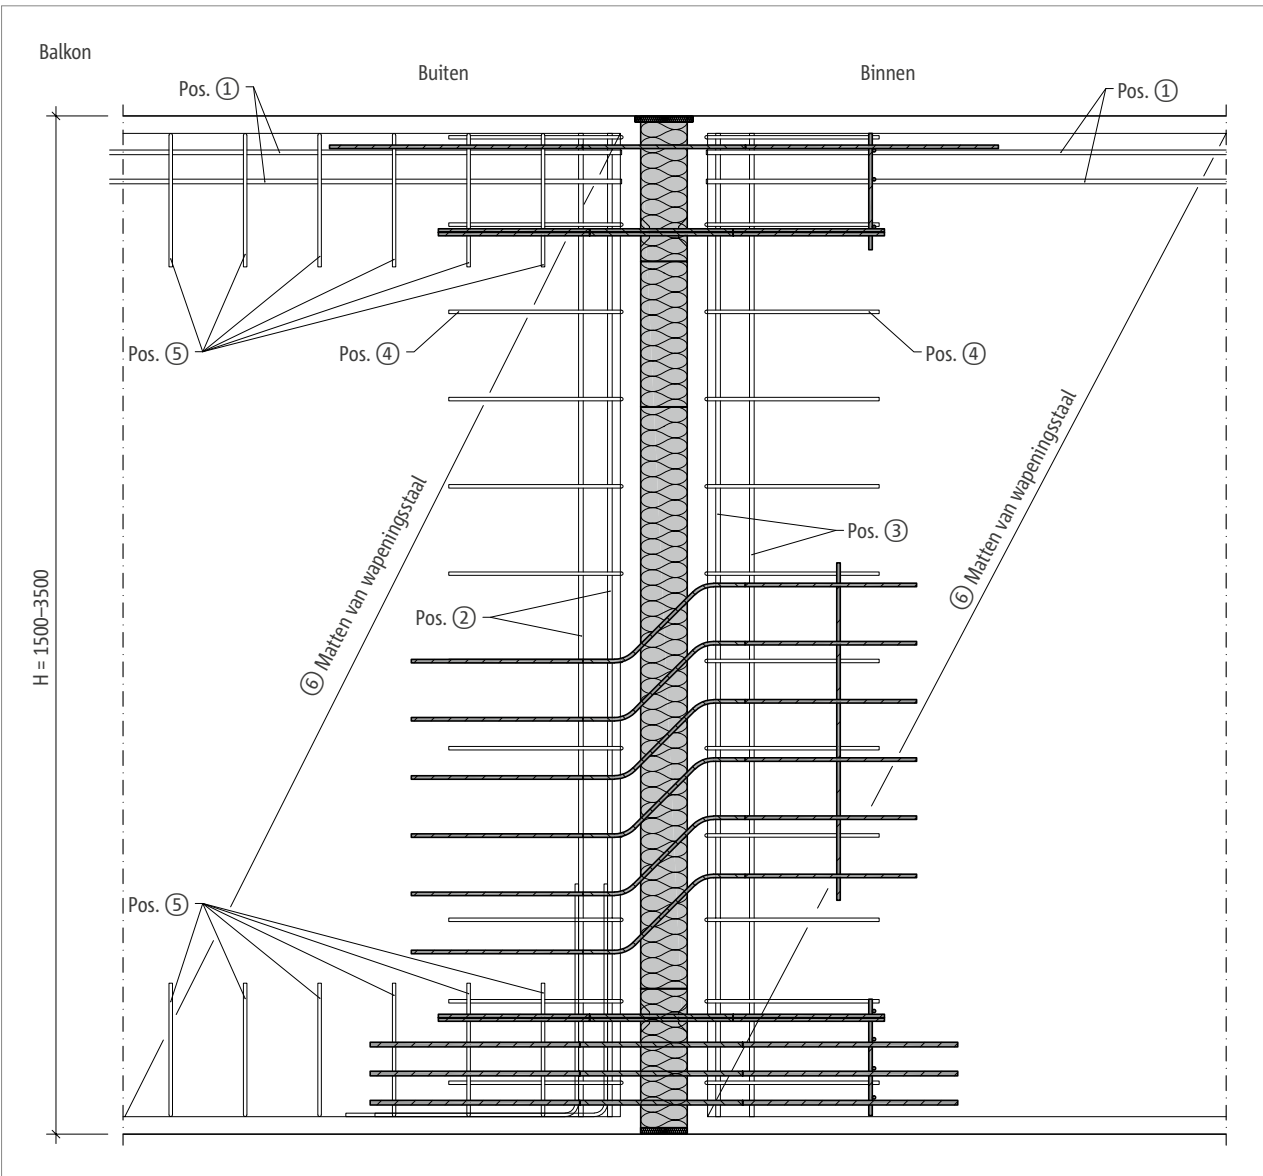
Schöck Isokorf® T type W-M4: Bovenaanzicht
